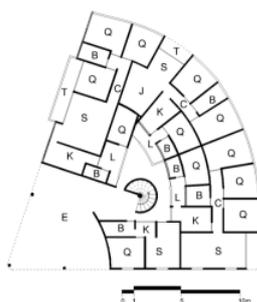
Planta Baixa Térreo. Fonte: Croqui da autora.
